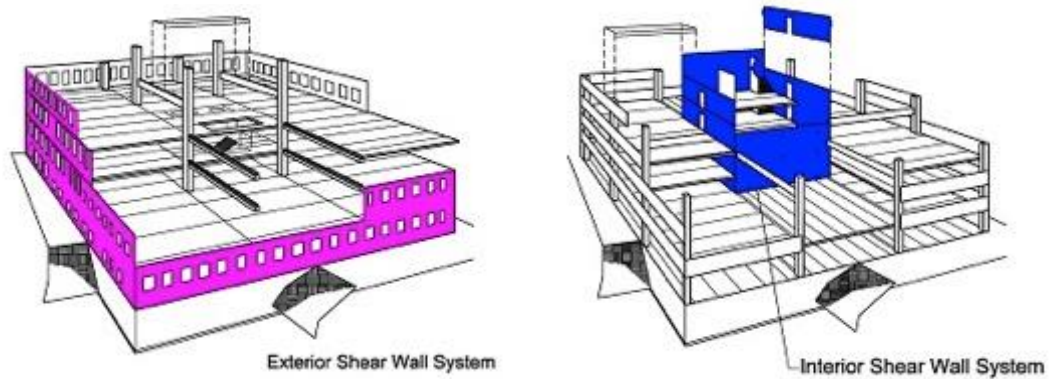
Sistemas de muros estructurales interiores y exteriores (PCI, s. f.).
